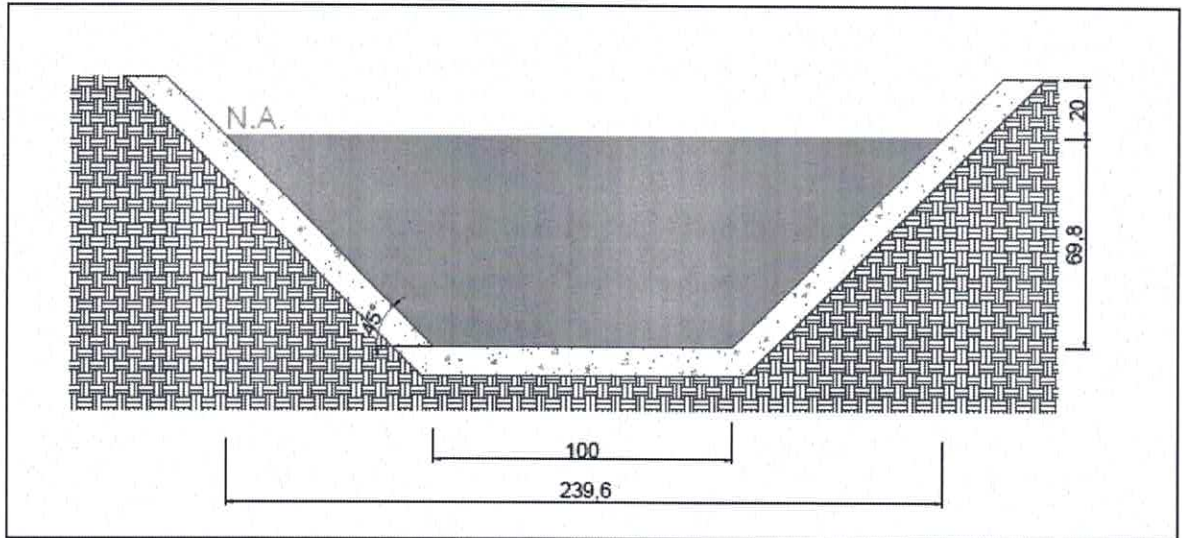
Corte transversal do canal trapezoidal revestido em pedra argamassada (medidas em cm)
